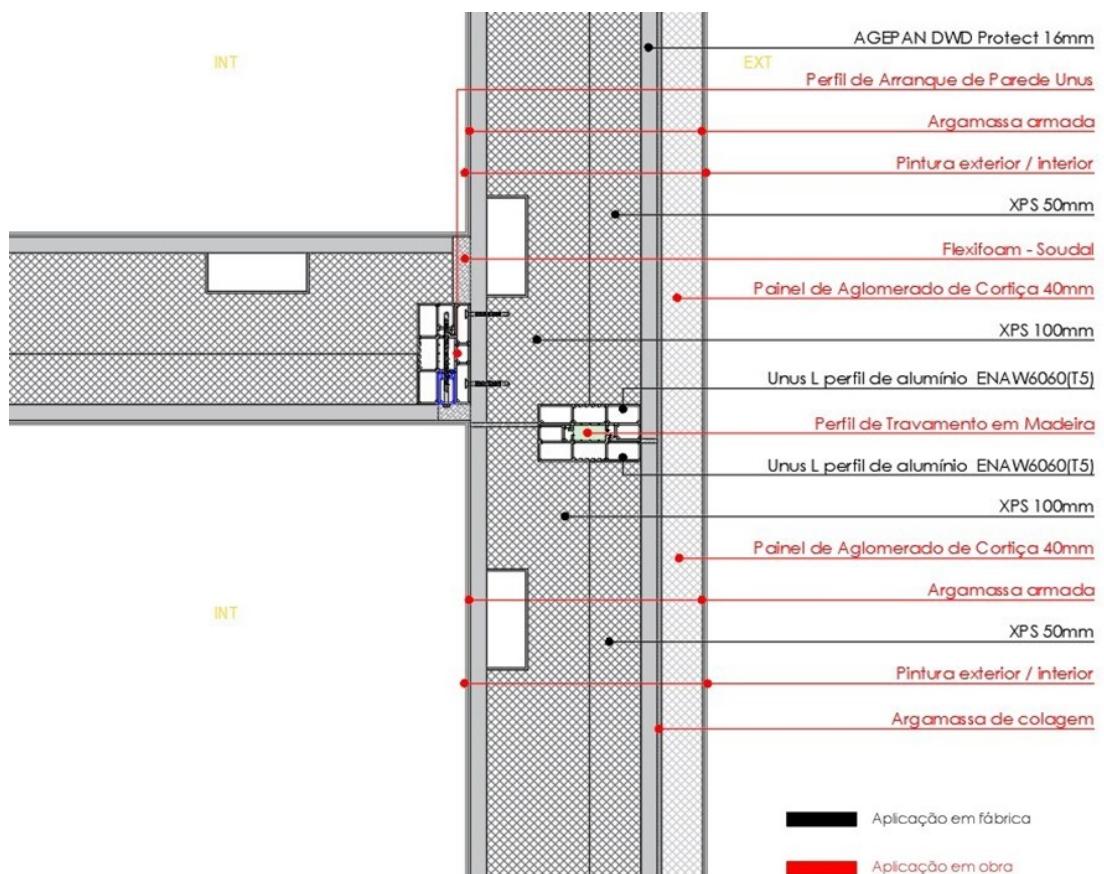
Solução Final – Pormenor construtivo de parede interior/parede exterior.
